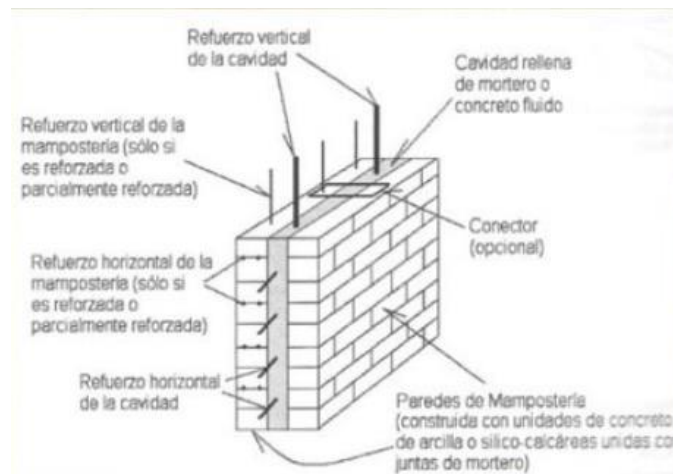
Mampostería de cavidad reforzada (http://blogguernuevo.blogspot.com/, 2016)
